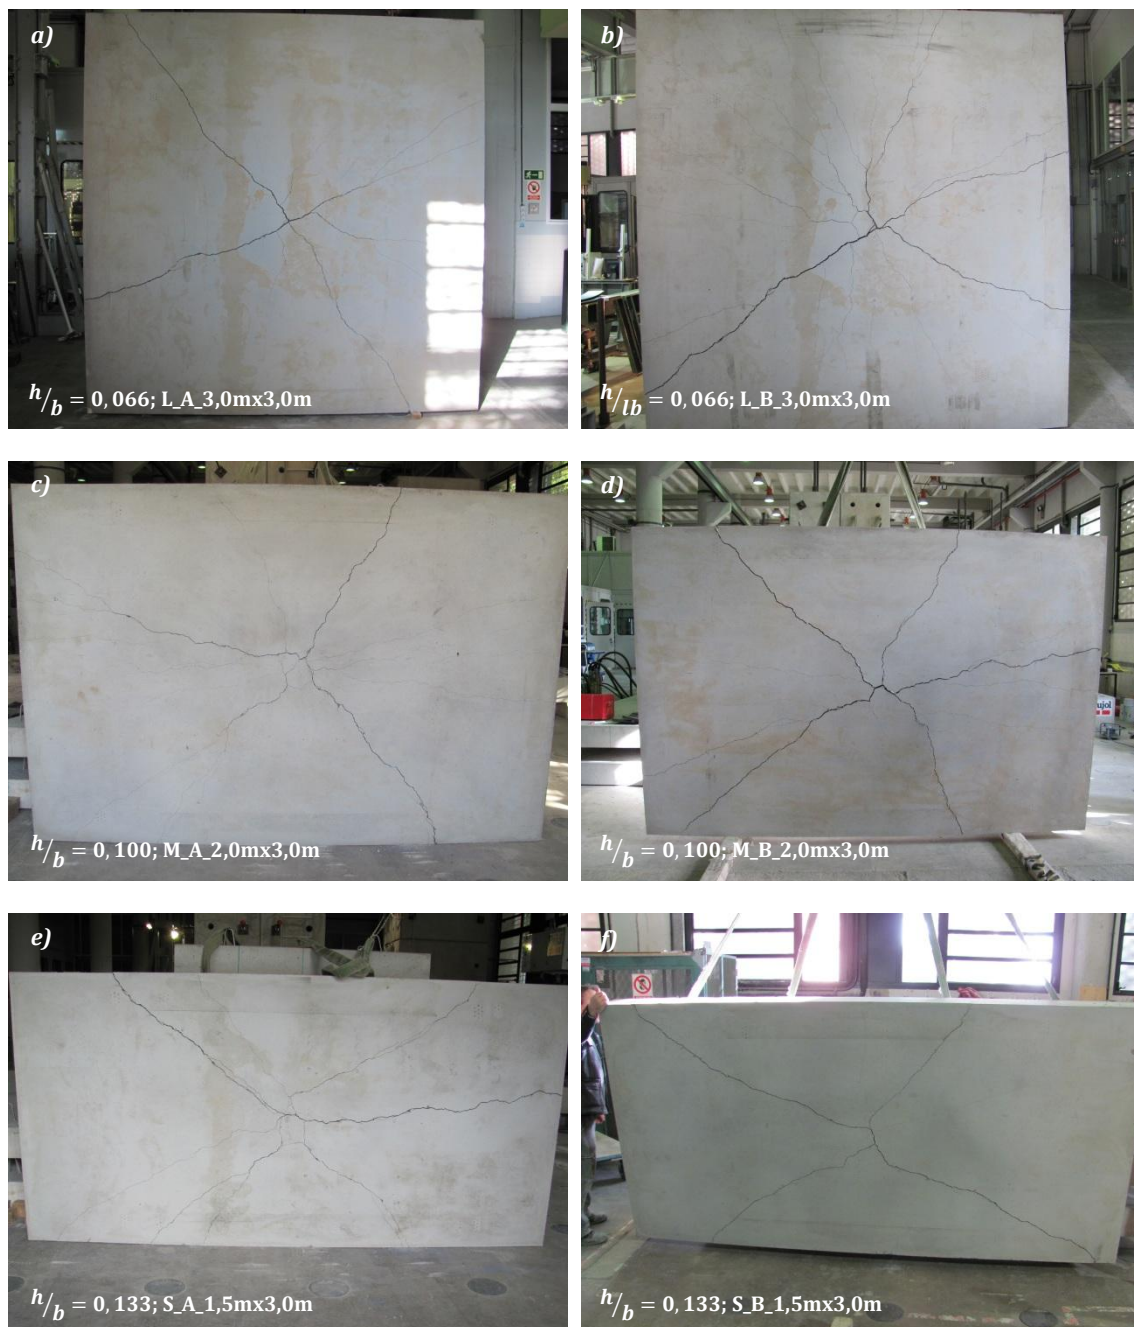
Fisuración de las losas tras el ensayo
